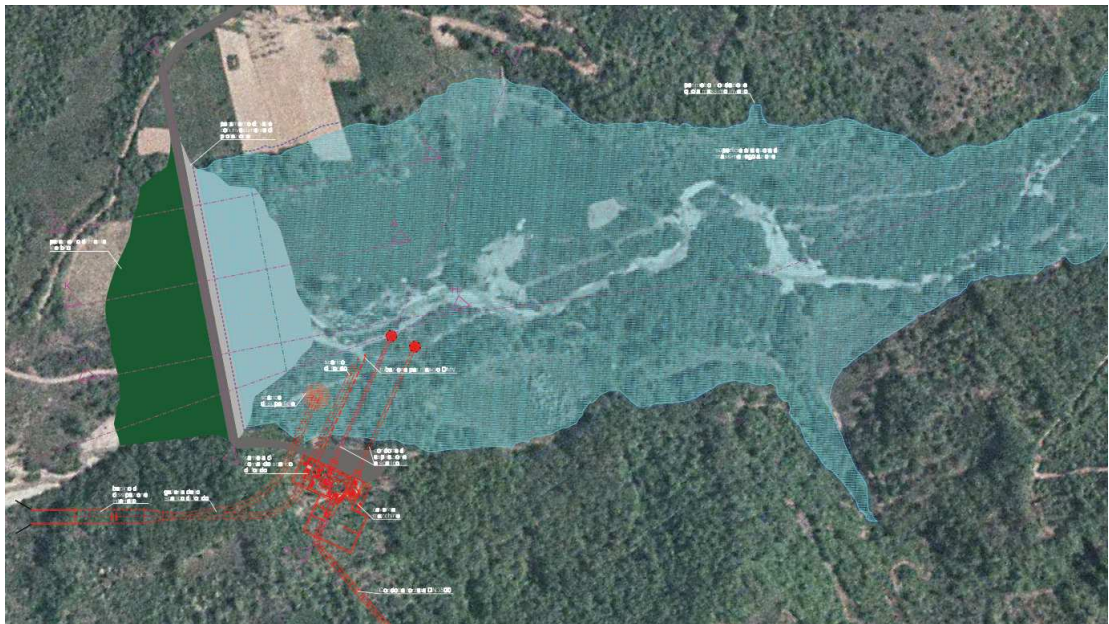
Planimetria di progetto dell'invaso di valle (estratto Tavola PD-EP.19).
